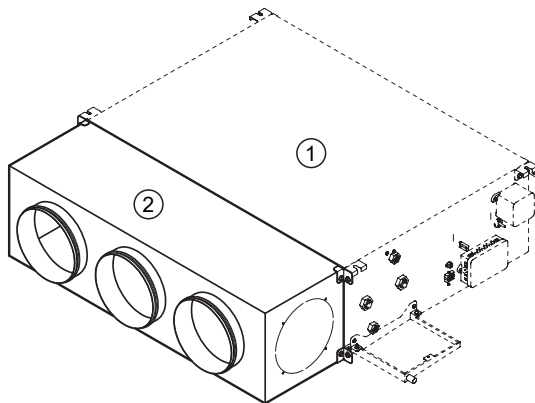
Grundgerät mit Anschlusseinheit für Rundrohr
